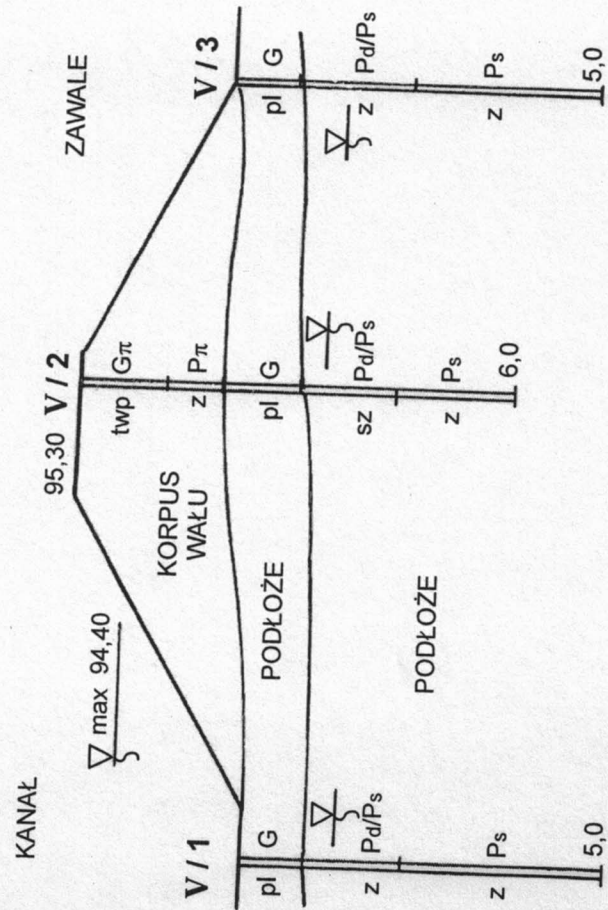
WAŁ LEWY PRZEKROJE GEOTECHNICZNE
